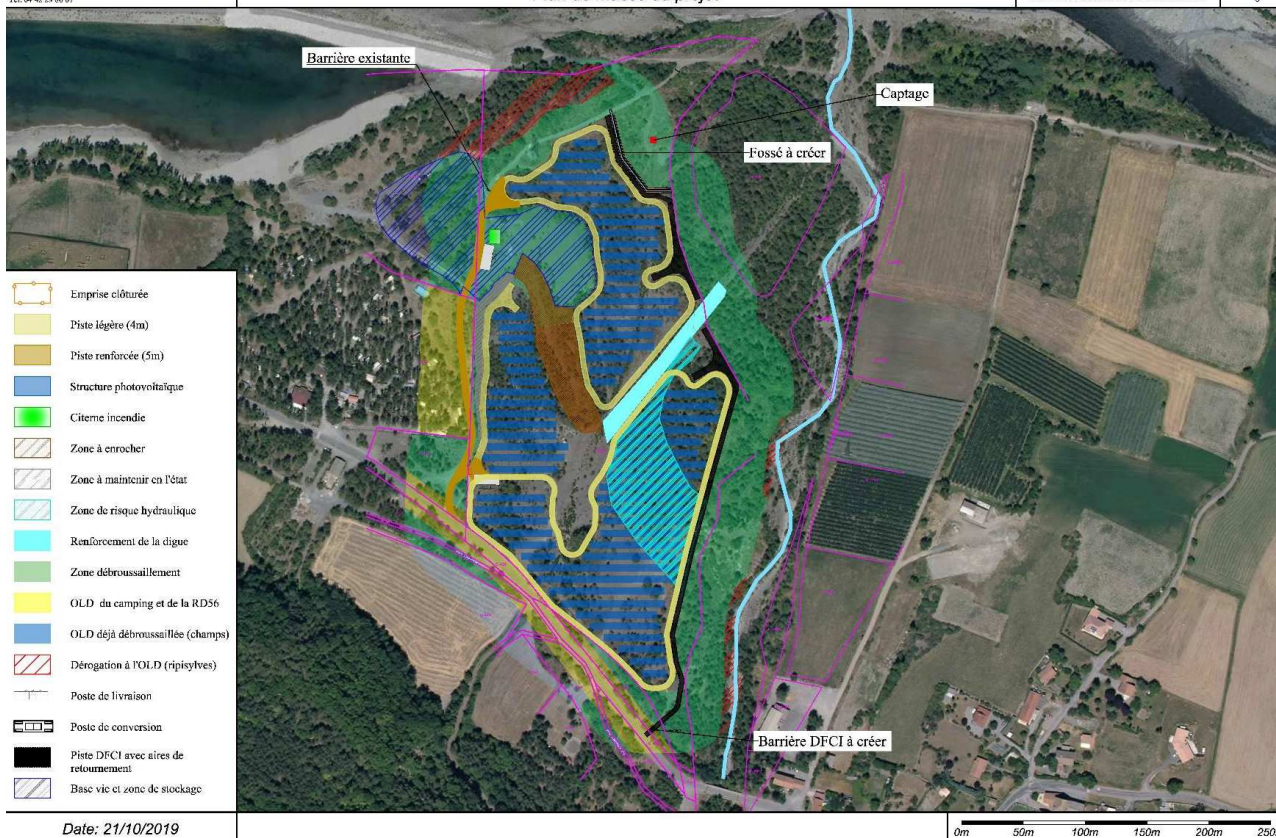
Plan masse du projet. Source : étude d'impact - Juin 2020.
